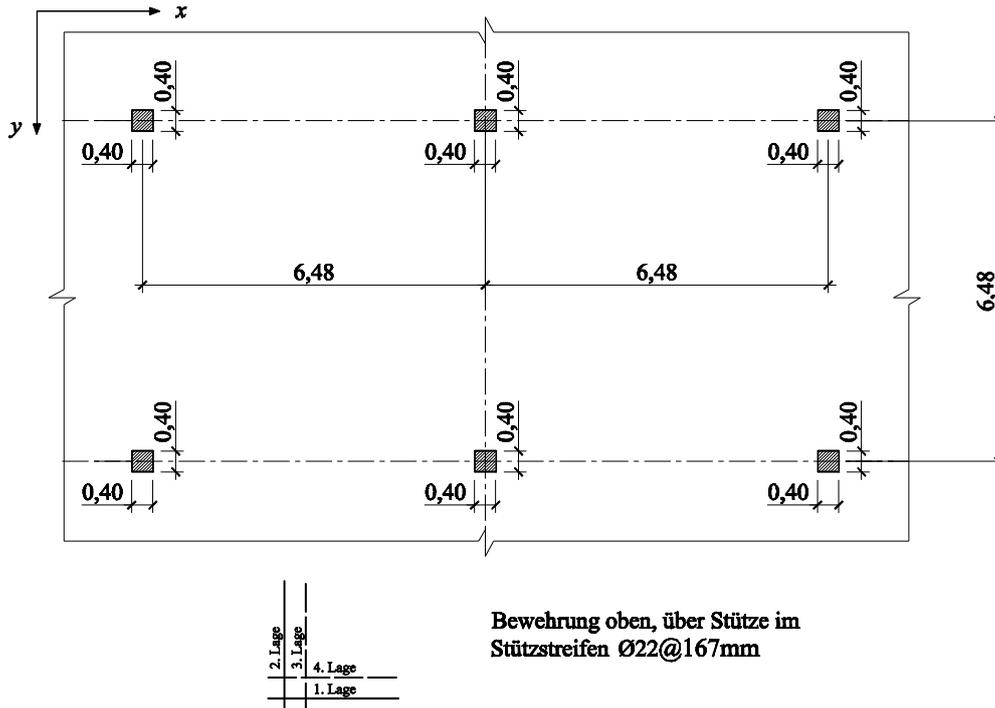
Lagerung, Abmessungen und Stützstreifenbewehrung der Platte. Abmessungen in m.
